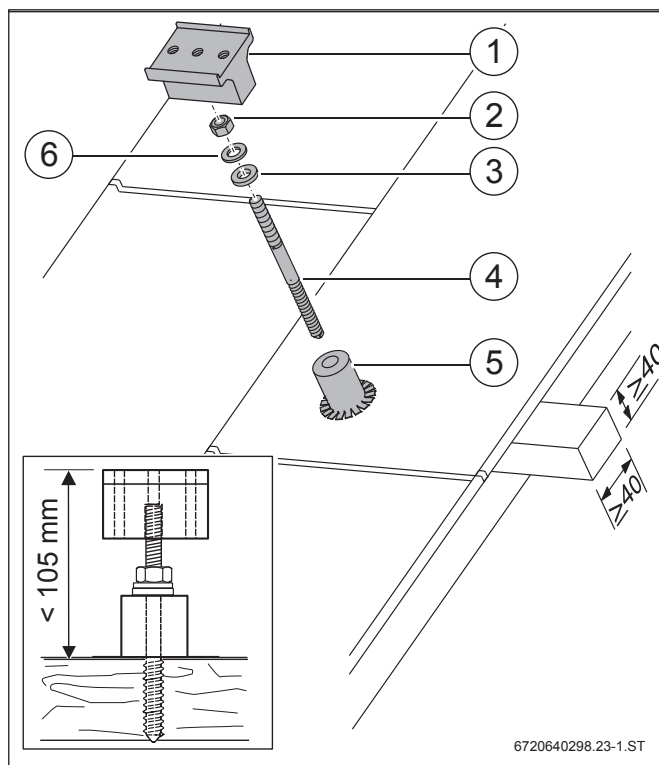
Przykład mocowania szyn profilowych w przypadku montażu na dachu spadzistym pokrytym płytami falistymi, wymiary w [mm]
